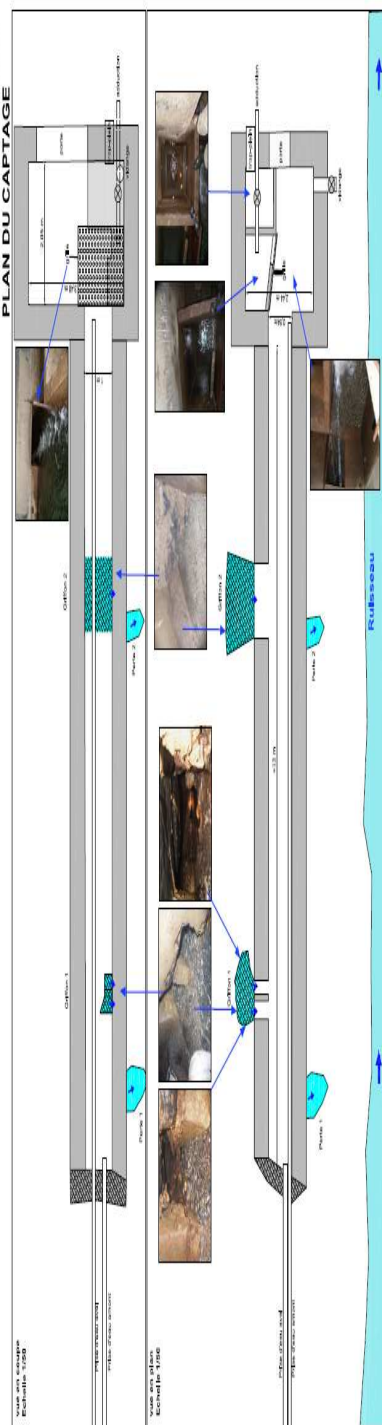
PLAN DE L'OUVRAGE DE CAPTAGE (document Cabinet Berre)
